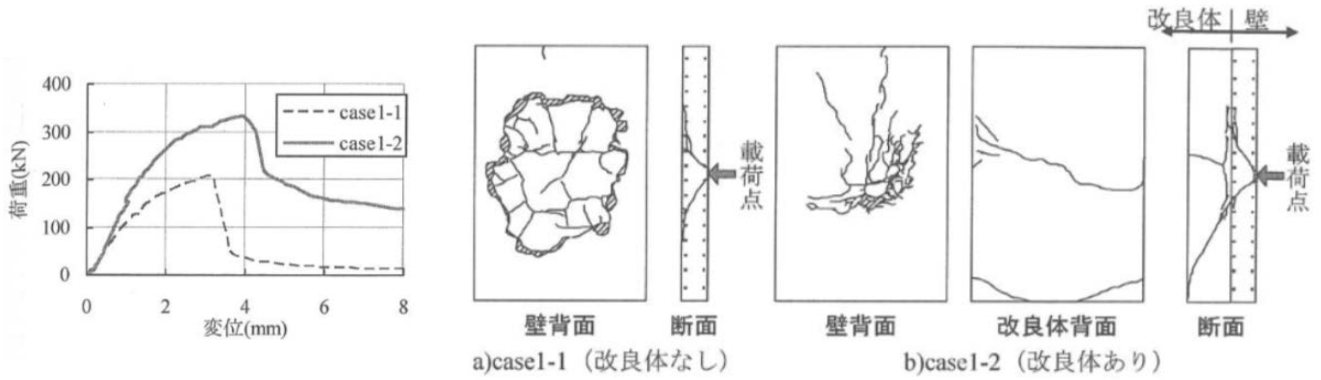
静的載荷試験結果（左：変位－荷重 右：背面及び断面のひび割れ状況）<sup>5)</sup>
